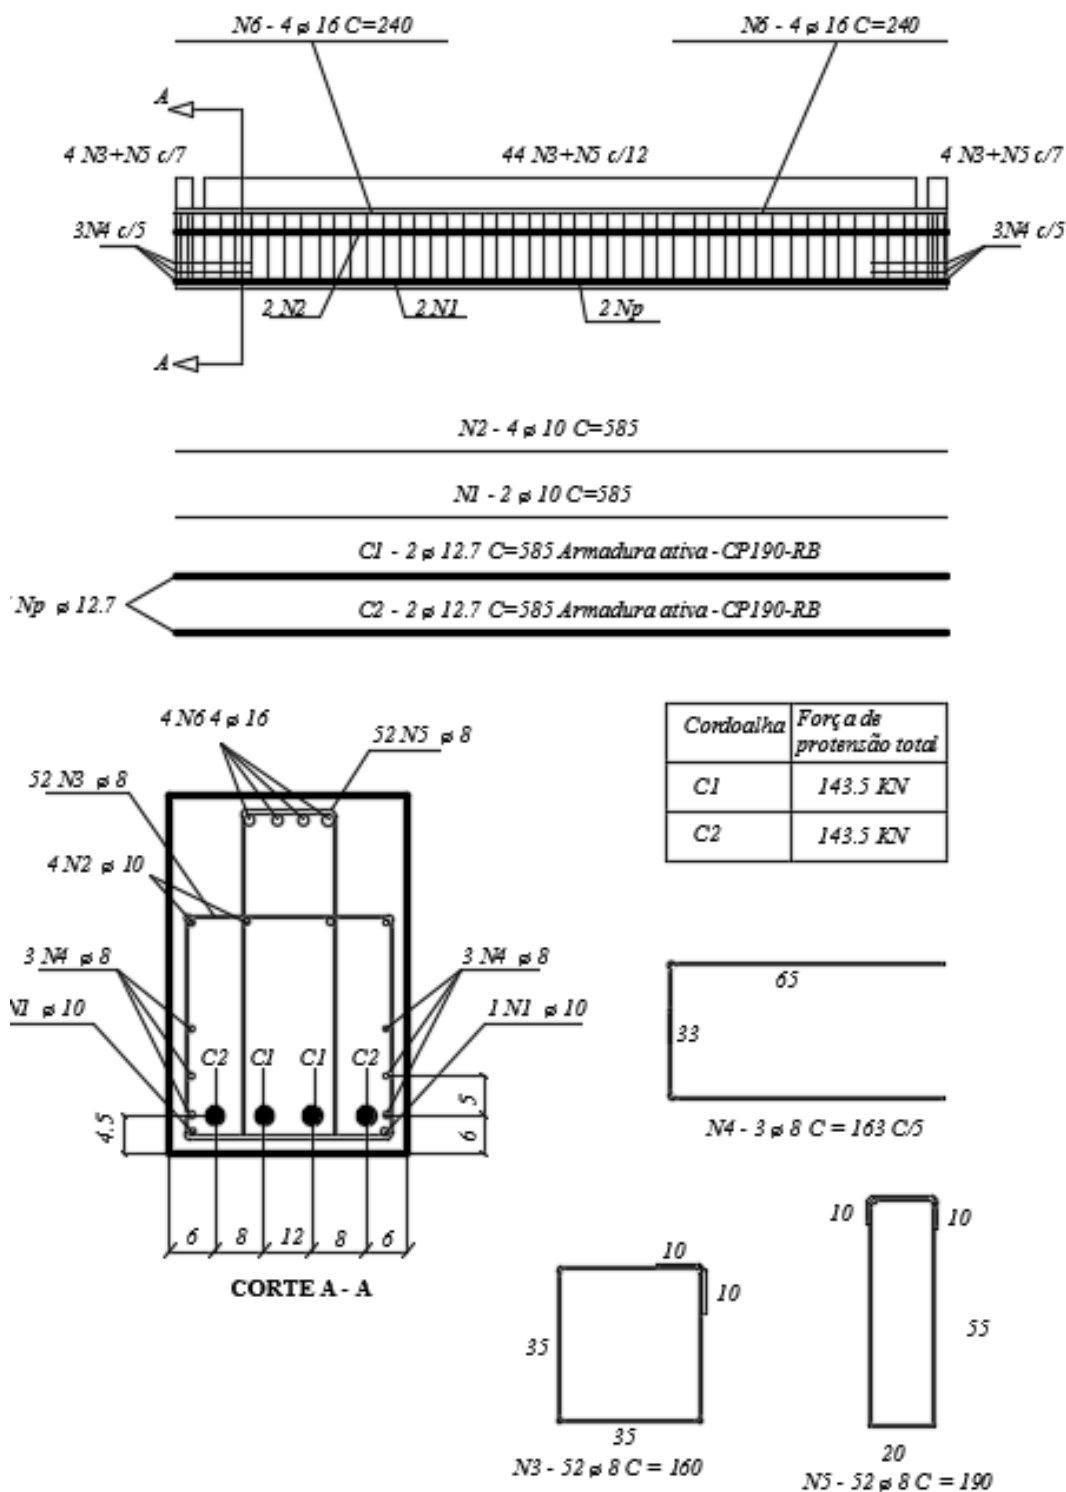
Detalhamento da viga pré-moldada ensaiada por Catoia (2007)
